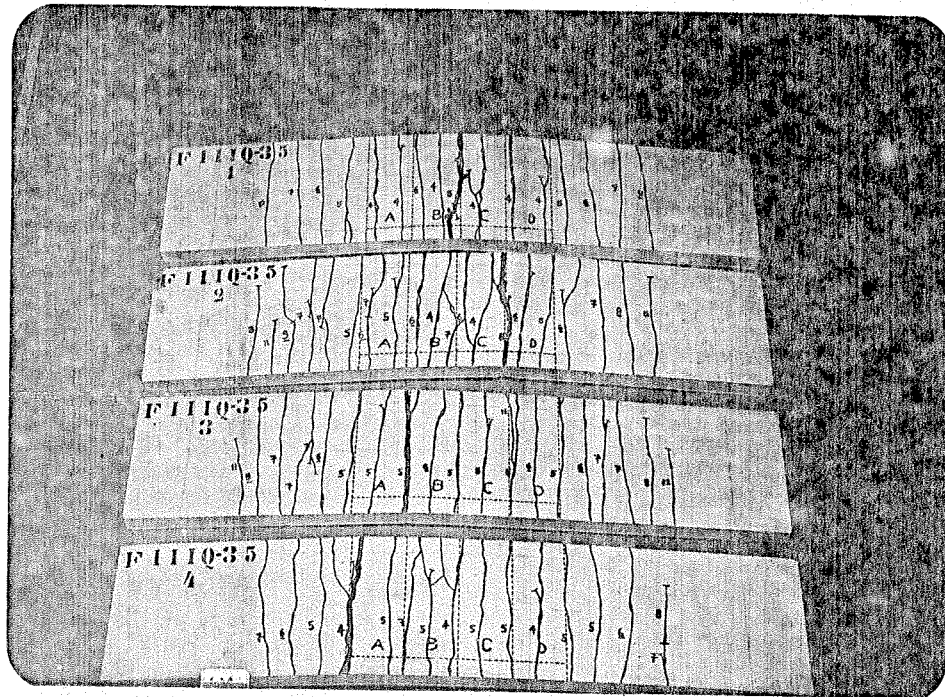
Fissuração final - SERIE F111035
